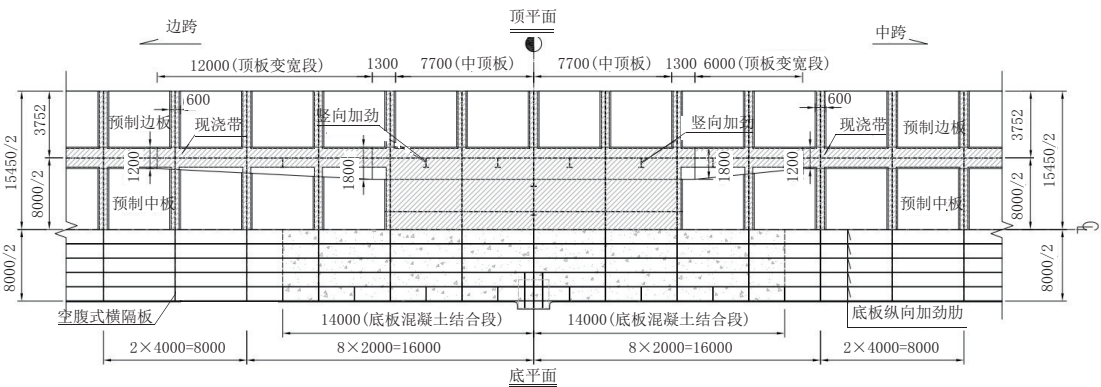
主梁中支点附近顶、底平面布置图(单位:mm)
